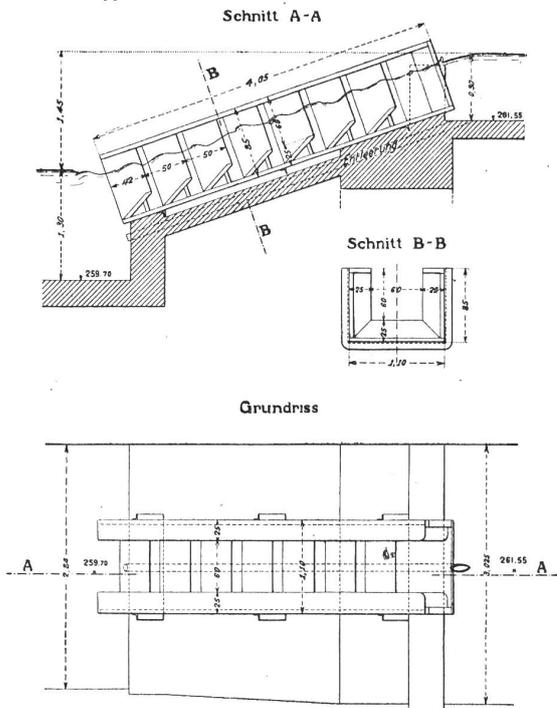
Elektrizitätswerk Augst. Grundriss und Schnitt einer Rinne der Deniltreppe. Maßstab 1 : 75.
